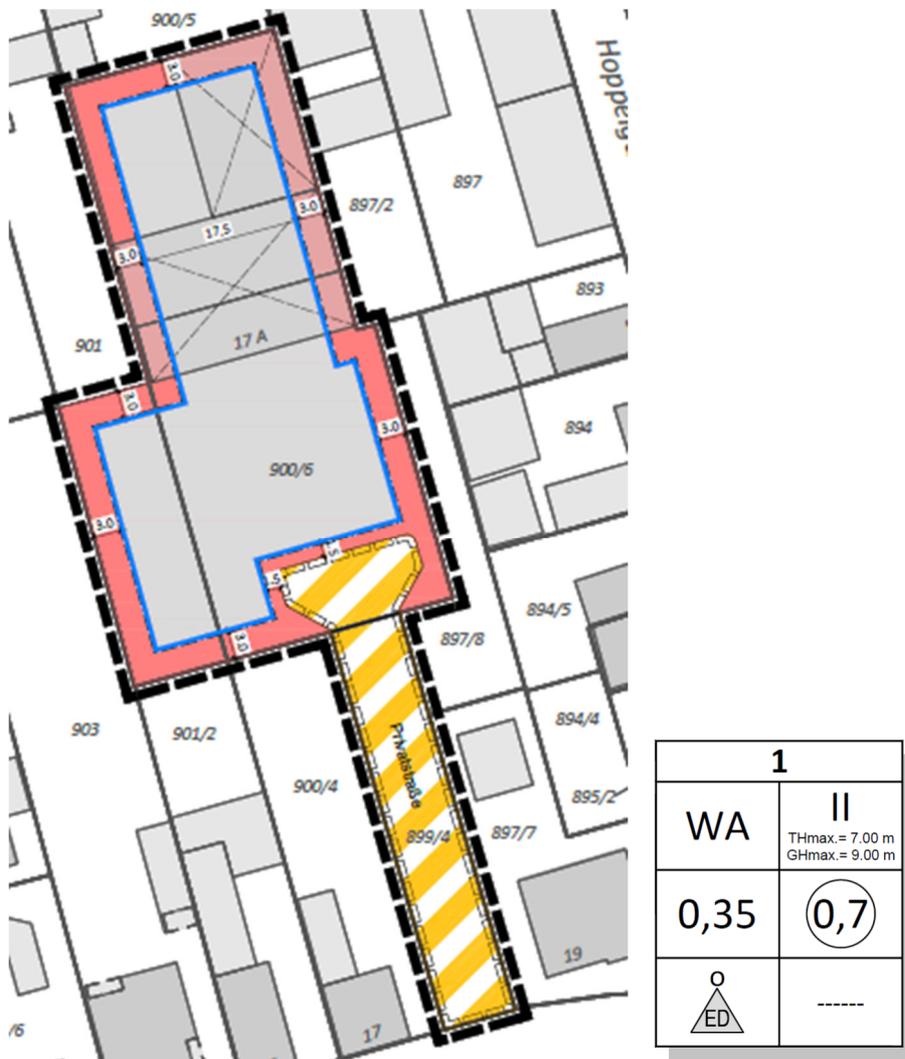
Bebauungsplanentwurf (Stand: 06/2025)
